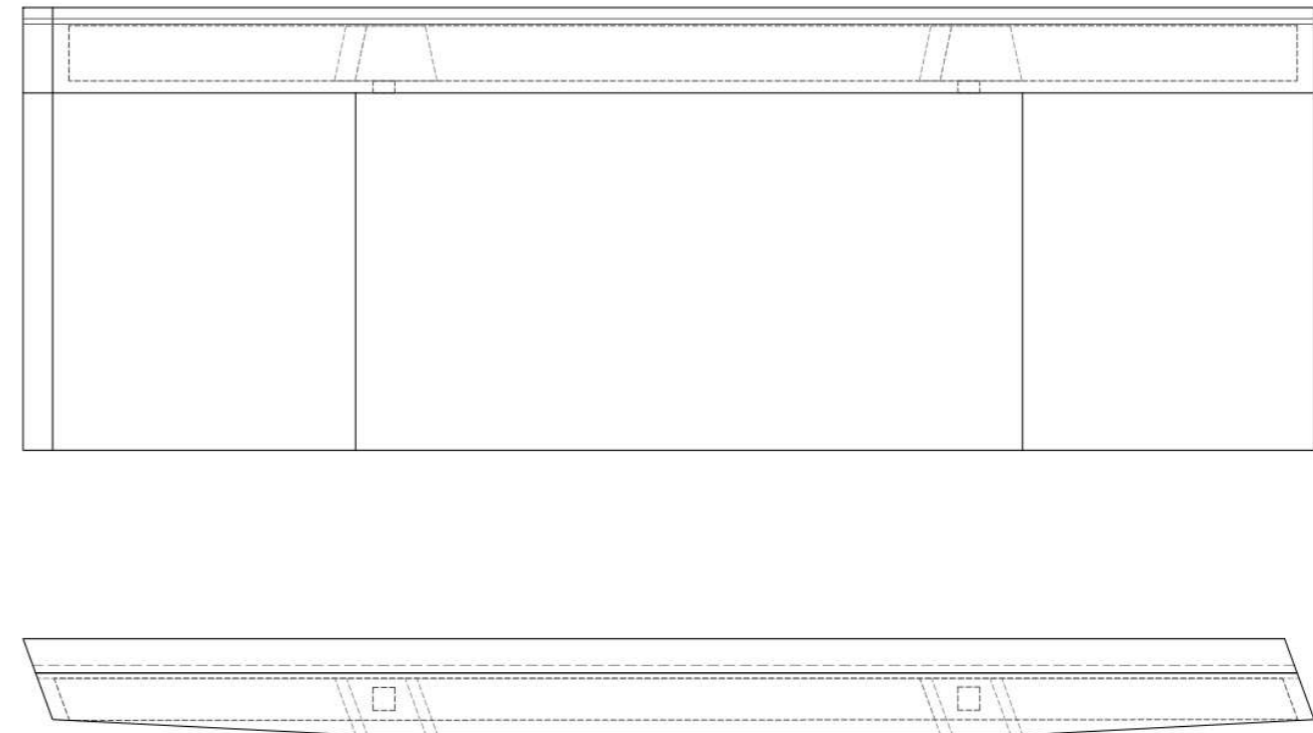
Vista en planta, y en alzado del estribo (fuente: elaboración propia)
